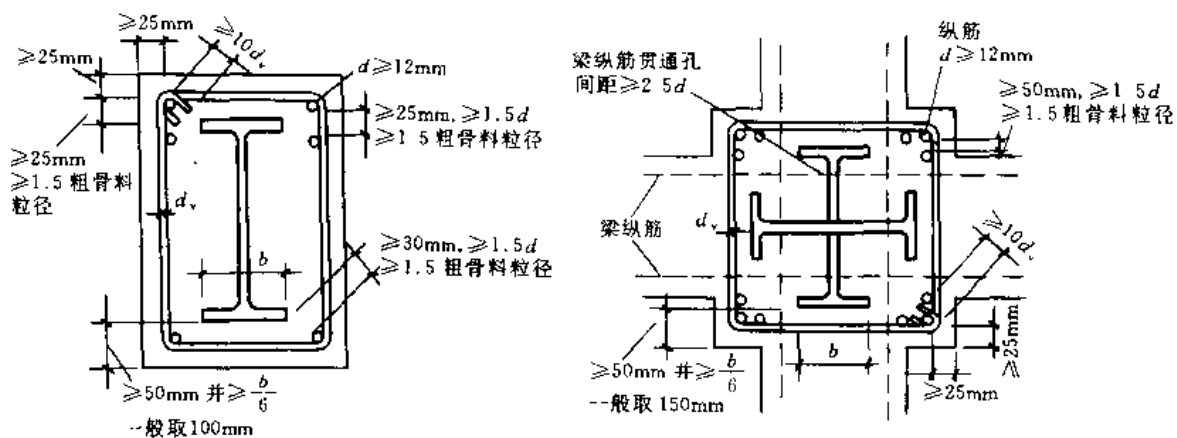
钢骨混凝土梁柱构件截面构造要求
